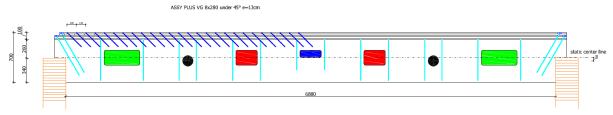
Deckenschnitt, Rippe mit TGA-Öffnungen (Quelle: ZÜBLIN Timber)
